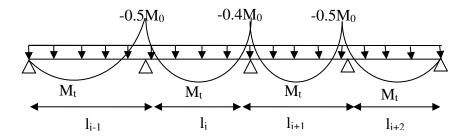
Moments sur une poutre à plus de deux travées
